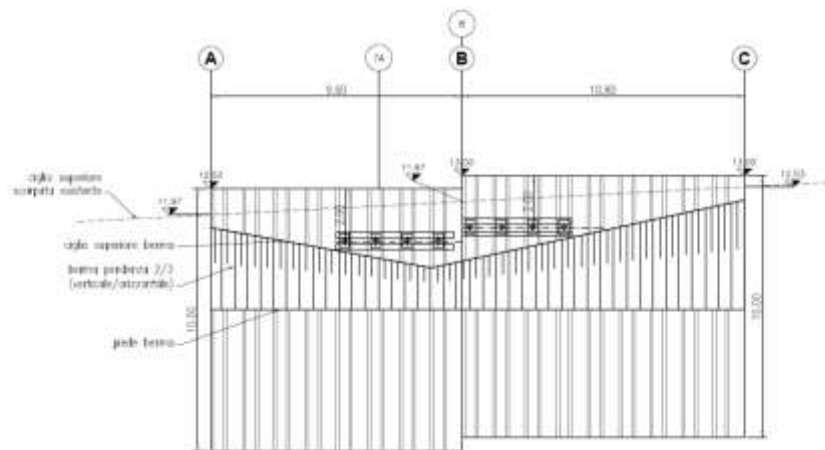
Muro spalla B: sviluppo in pianta palancola
